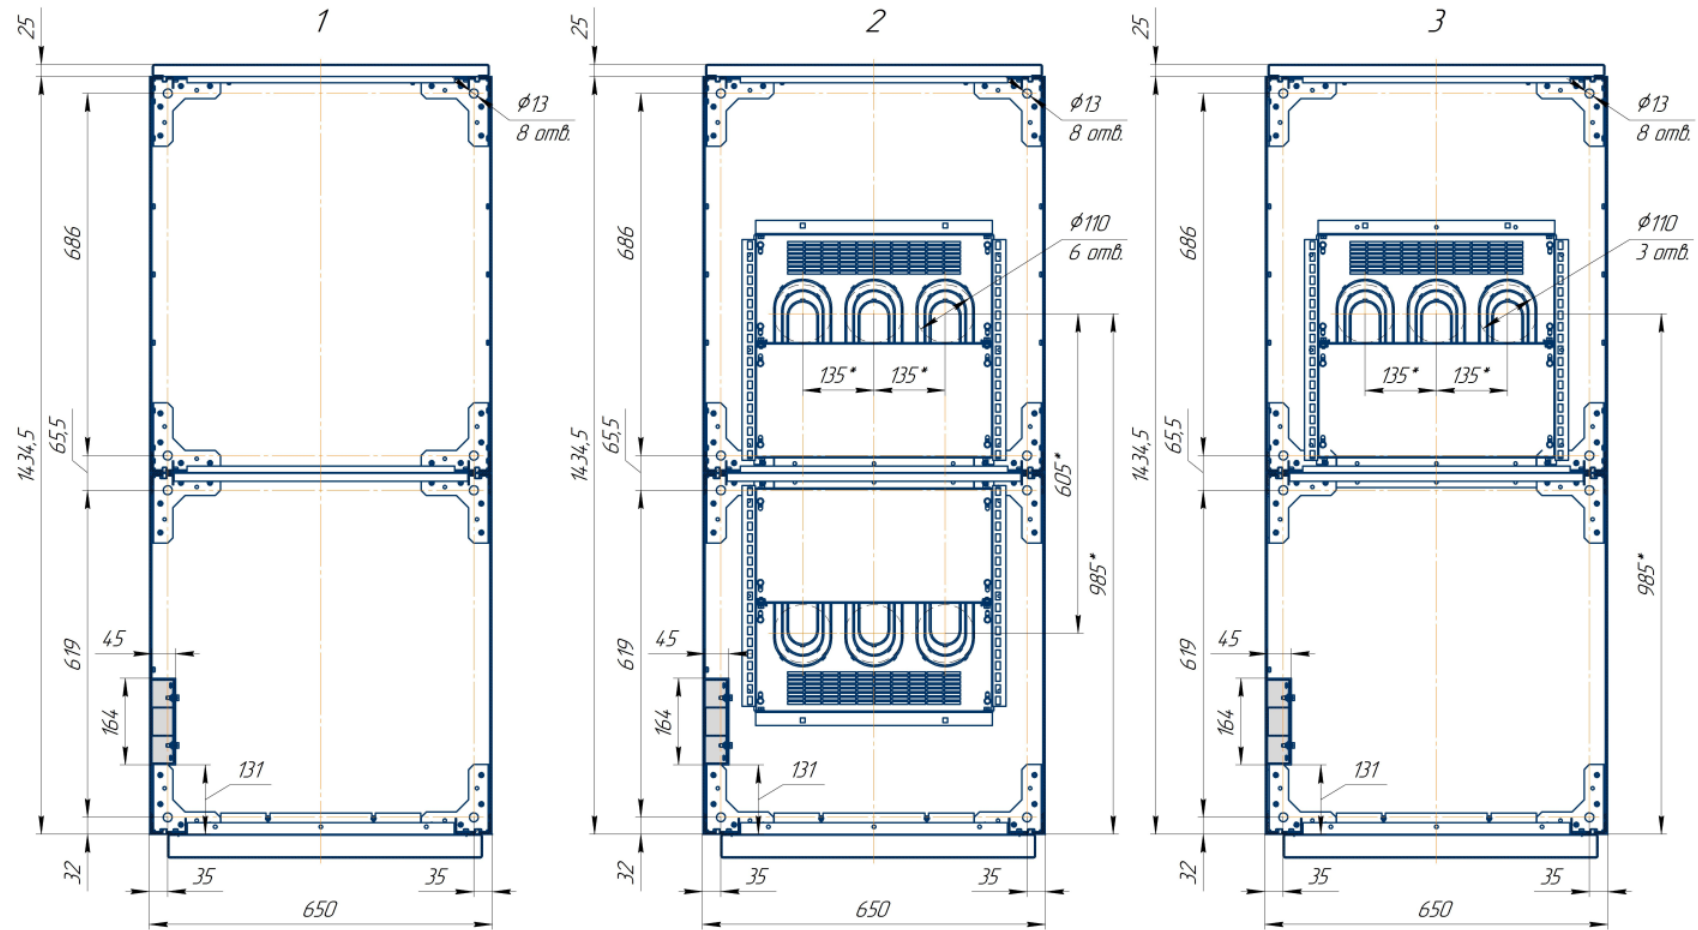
Установка КРУ-70-BLISS шириной 650мм на фундамент
